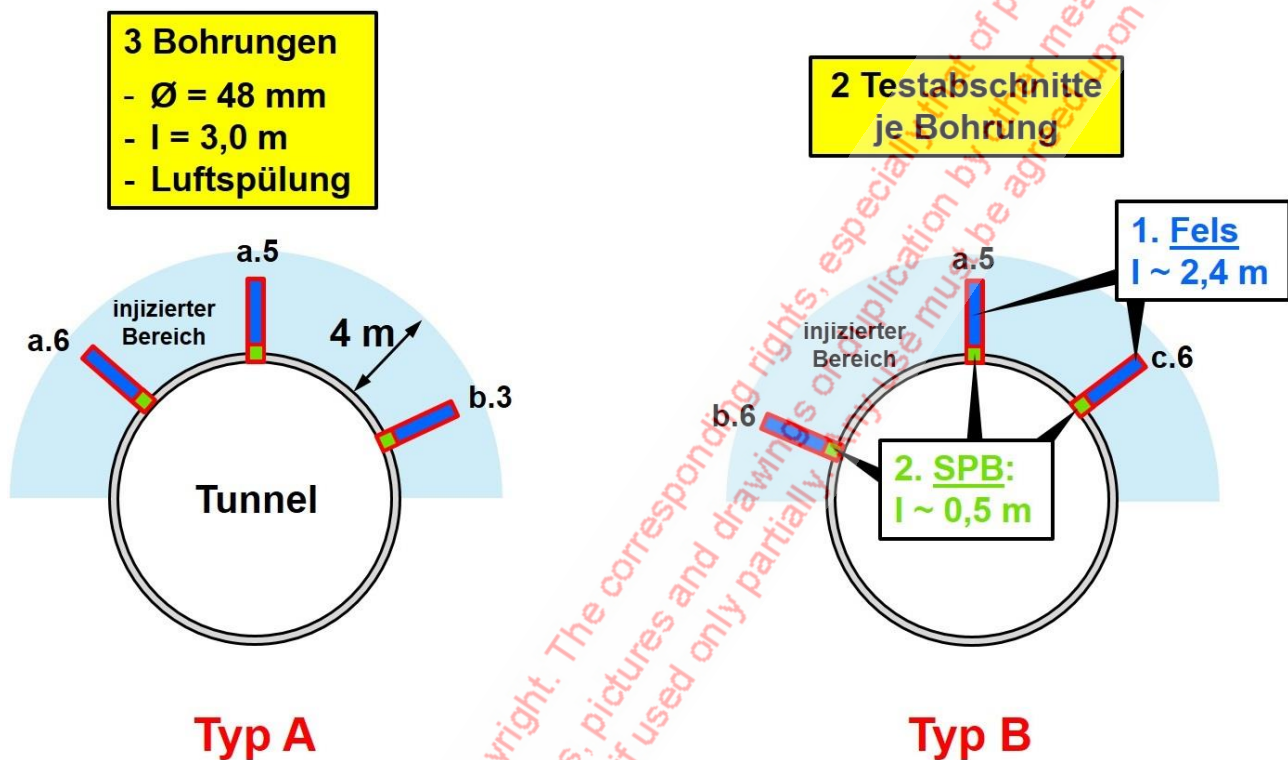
Versuchsquerschnitte mit Bohrungen und Testabschnitten
